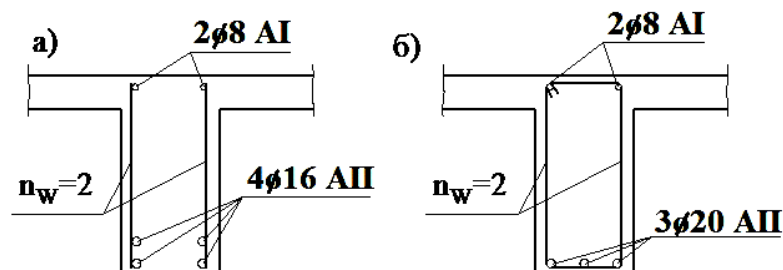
Схема армування перерізу балки зварними (а) і в'язаними (б) каркасами
